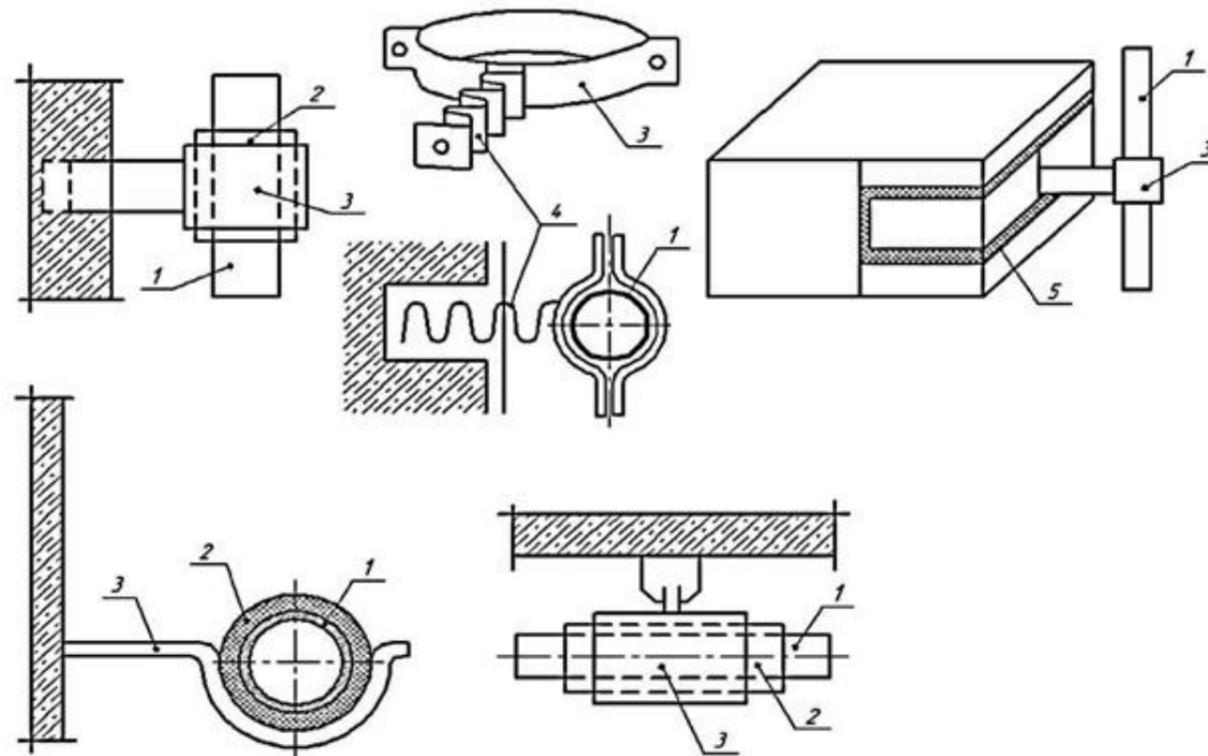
Схемы крепления труб центрального отопления к стенам и перекрытиям отопительного узла:
